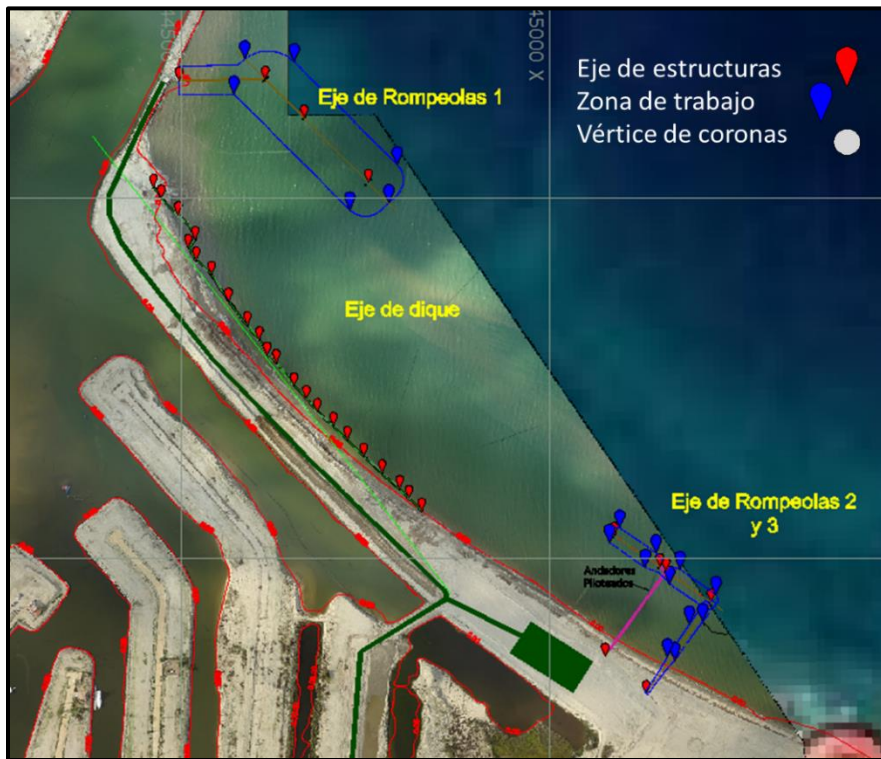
Trazo de estructuras y elementos del proyecto.
